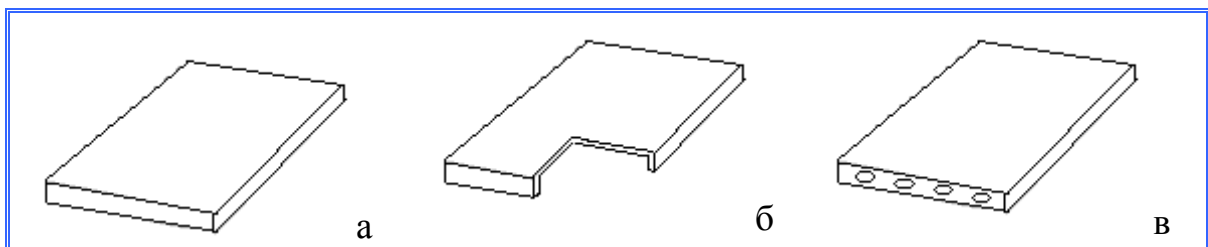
Збірні залізобетонні панелі перекриття: а – суцільна; б – ребриста; в – кругло пустотна.
